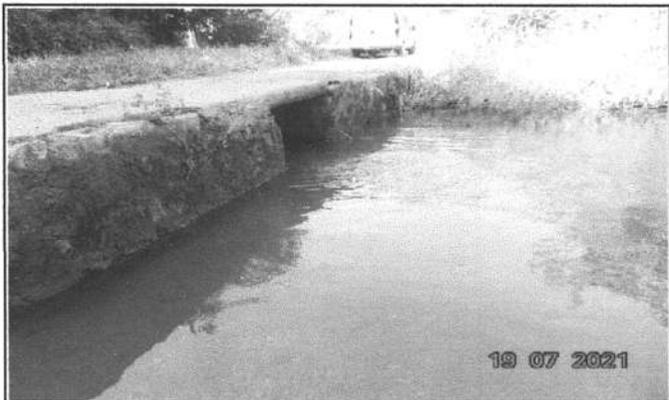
LOCAL DA CONSTRUÇÃO - BUEIRO
